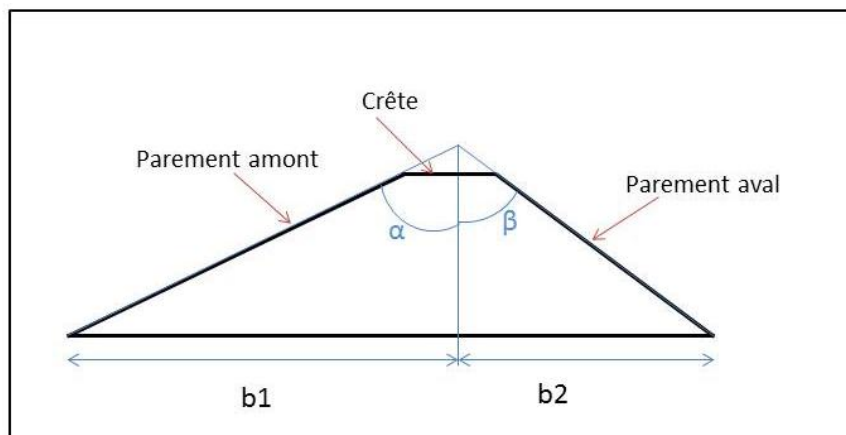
Schéma de la coupe transversale du barrage de Laàdira
